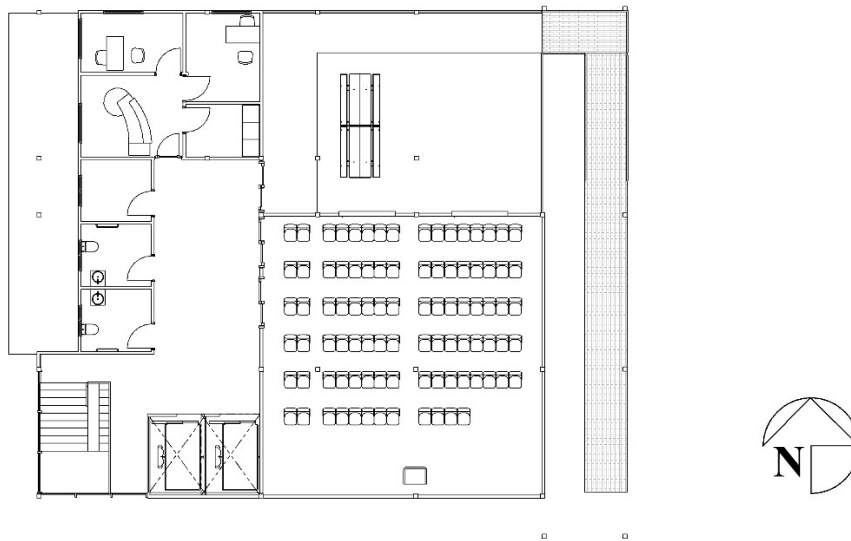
Planta Edificio 1, nivel 2, Zona 2, sin escala.
